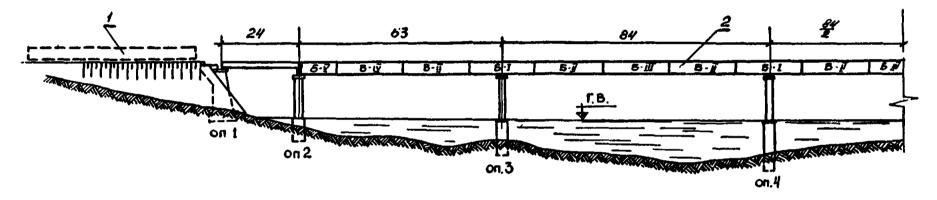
Схема автодорожного моста: 1—строительная площадка тылового монтажа секции пролетного строения; 2—металлическое пролетное строение
